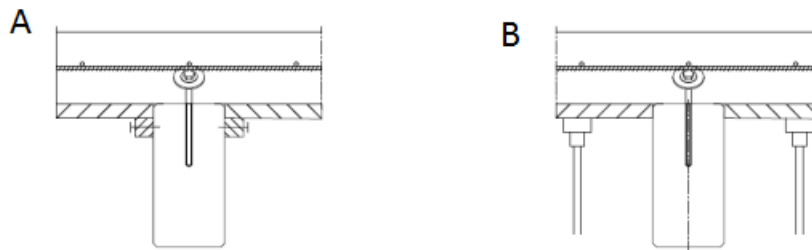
A: montaje con encofrado recuperable; B: montaje con la técnica de apuntalamiento habitual.
